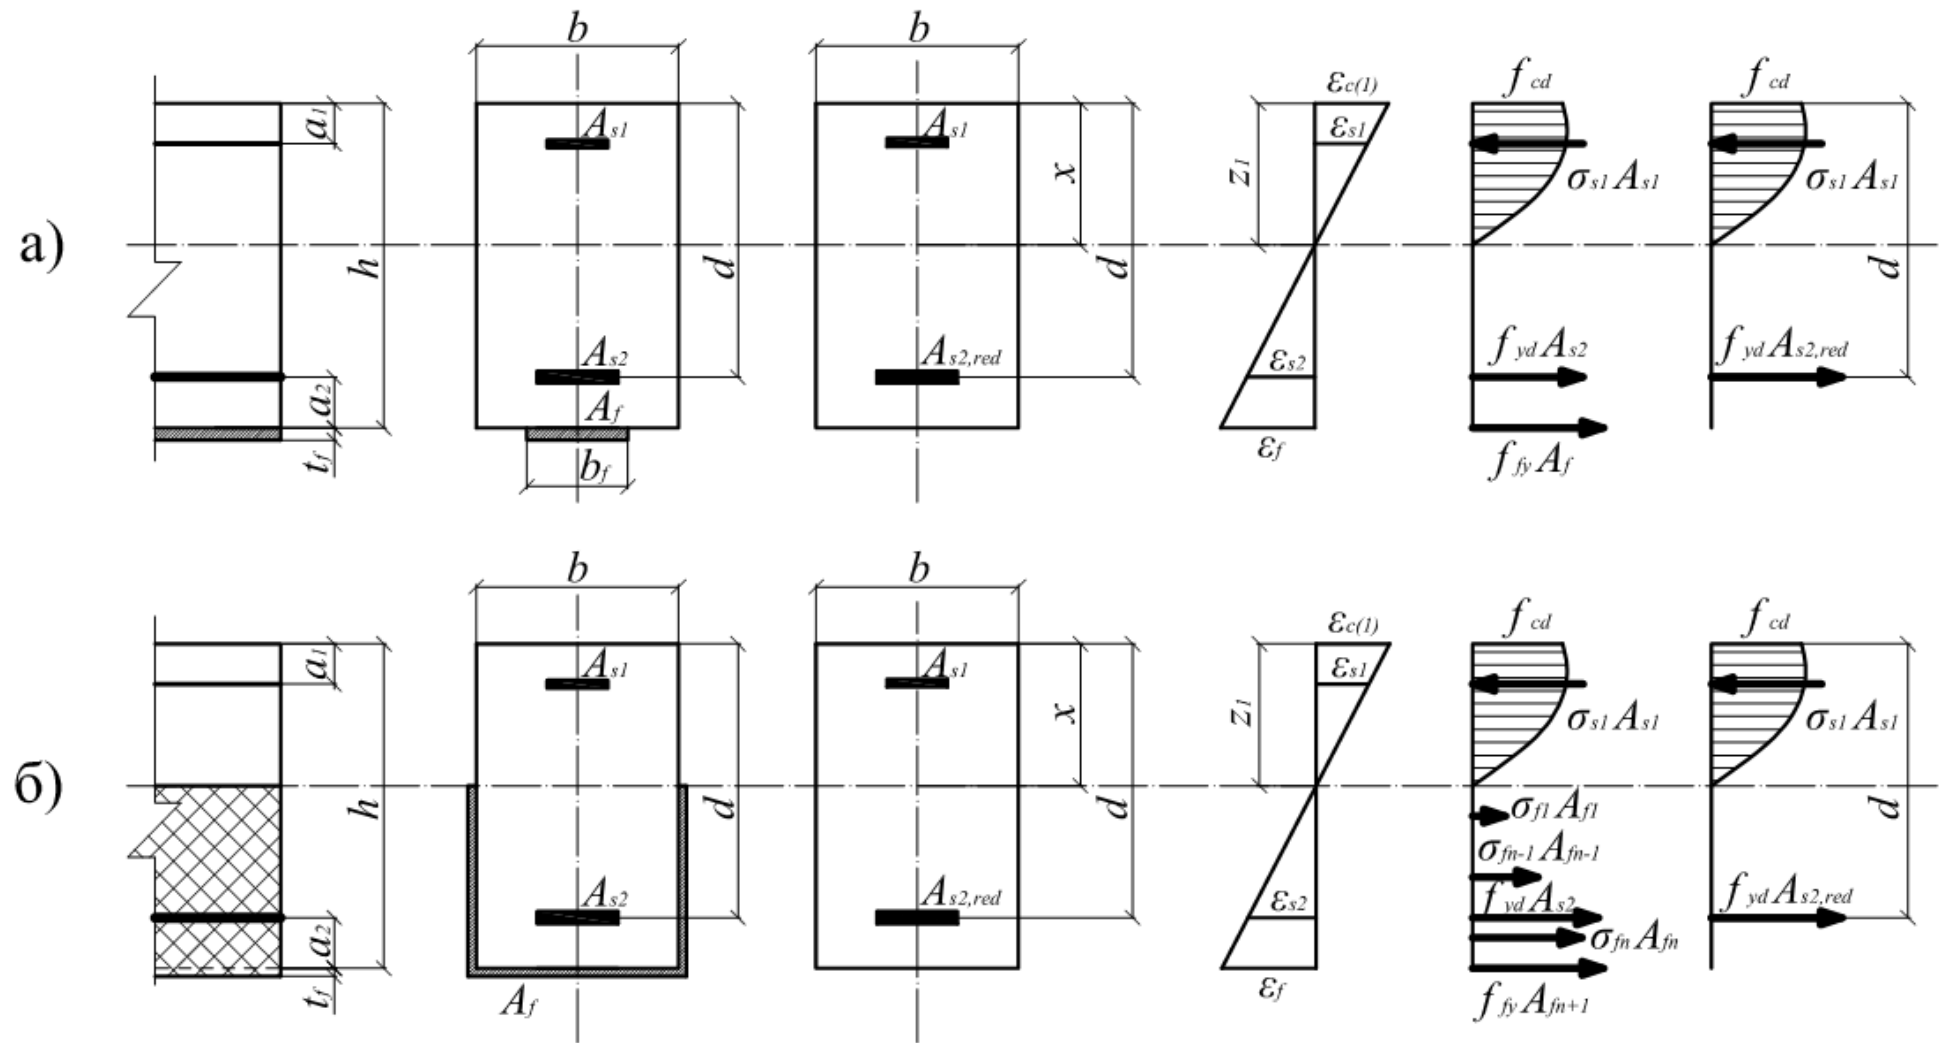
Розрахункова схема нормального перерізу залізобетонної балки підсиленої: а) – композитною стрічкою; б) – композитним полотном
